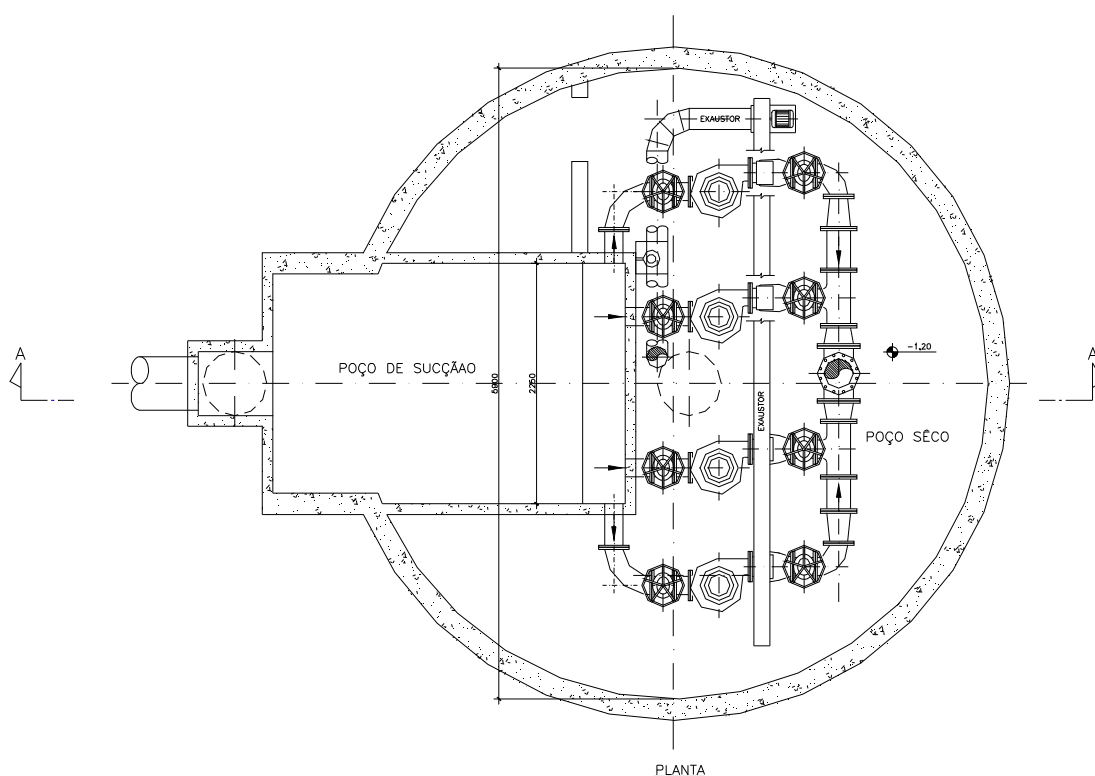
Planta da Elevatória José Mariano. *Fonte:* Adaptado do Cadastro Técnico da CEDAE – Arquivo Técnico da Paralela I Consult em Eng. Ltda.
